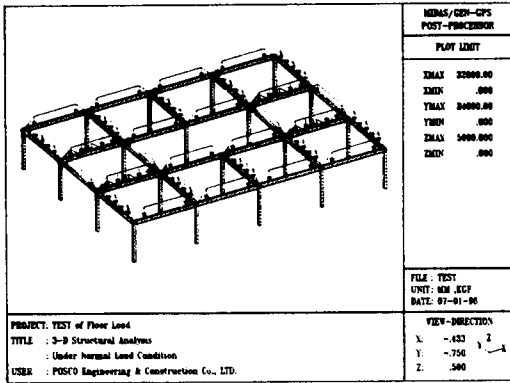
하중작용의 도시 예 (집중+Floor Load의 작용)
